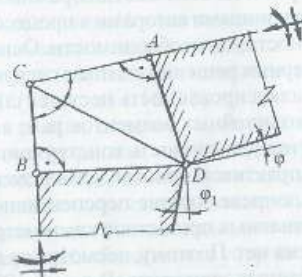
Расчетная схема карнизного узла рамы из досок с перекрестной стенкой на гвоздях
